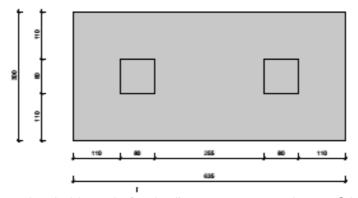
vista superior do bloco de fundação concreto armado aço CA50, concreto C25
